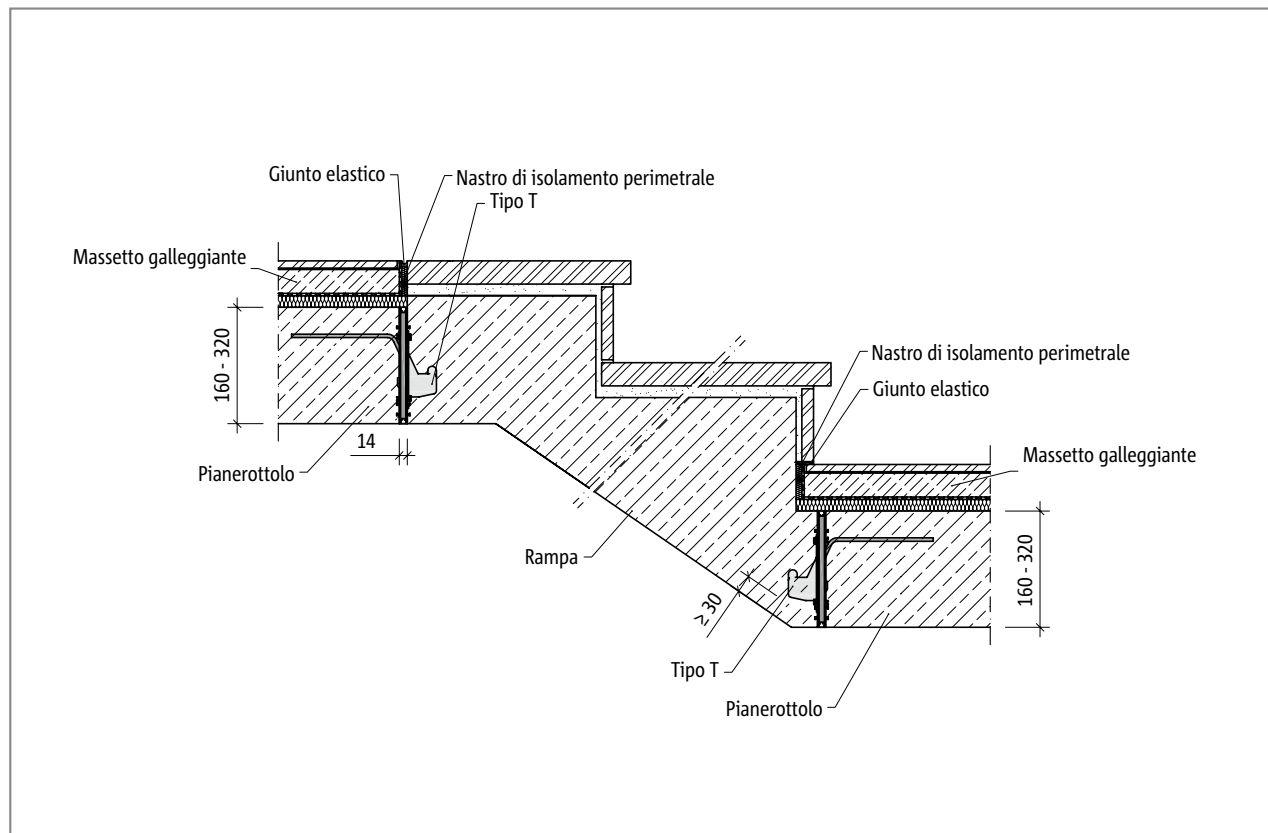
Schöck Tronsole® tipo T, Sezione costruttiva
